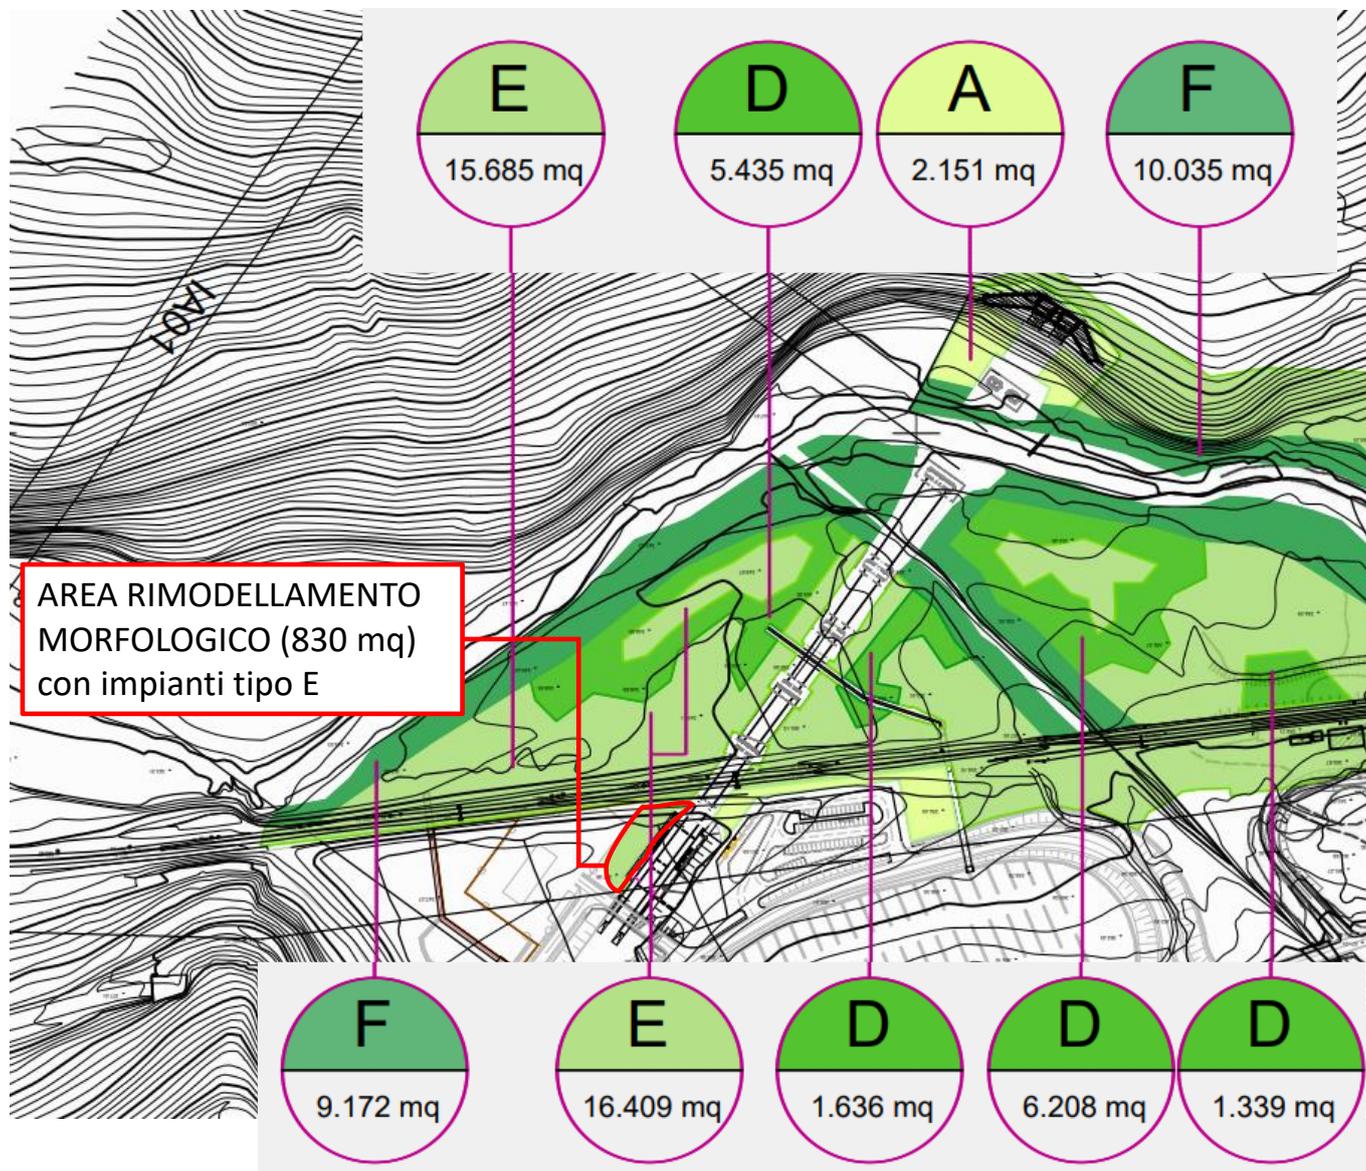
Stralcio della tavola "Planimetria degli interventi Opere a verde – Tav. 1" del Progetto Esecutivo
